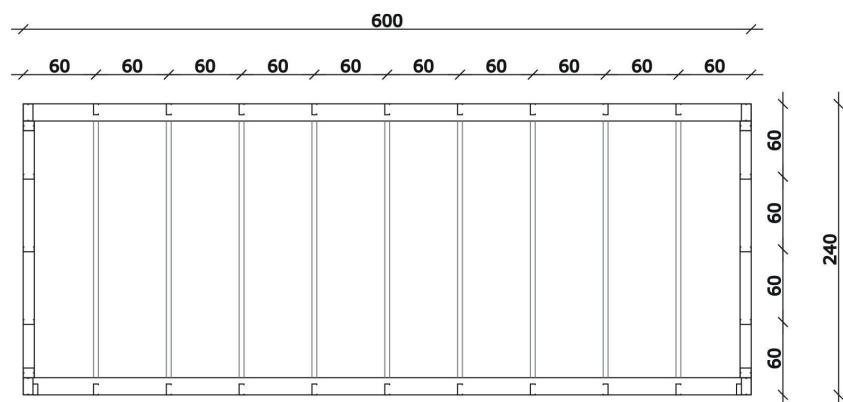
Planta baixa esquemática do módulo (em centímetros)
